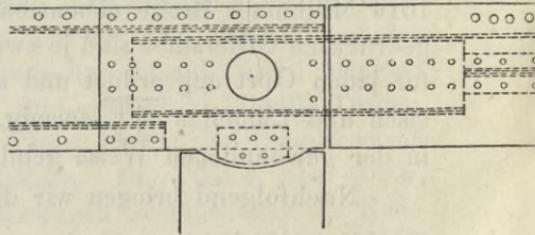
Grundriss des unteren Knotenpunktes am Gelenk (1:50 nat. Grösse).
